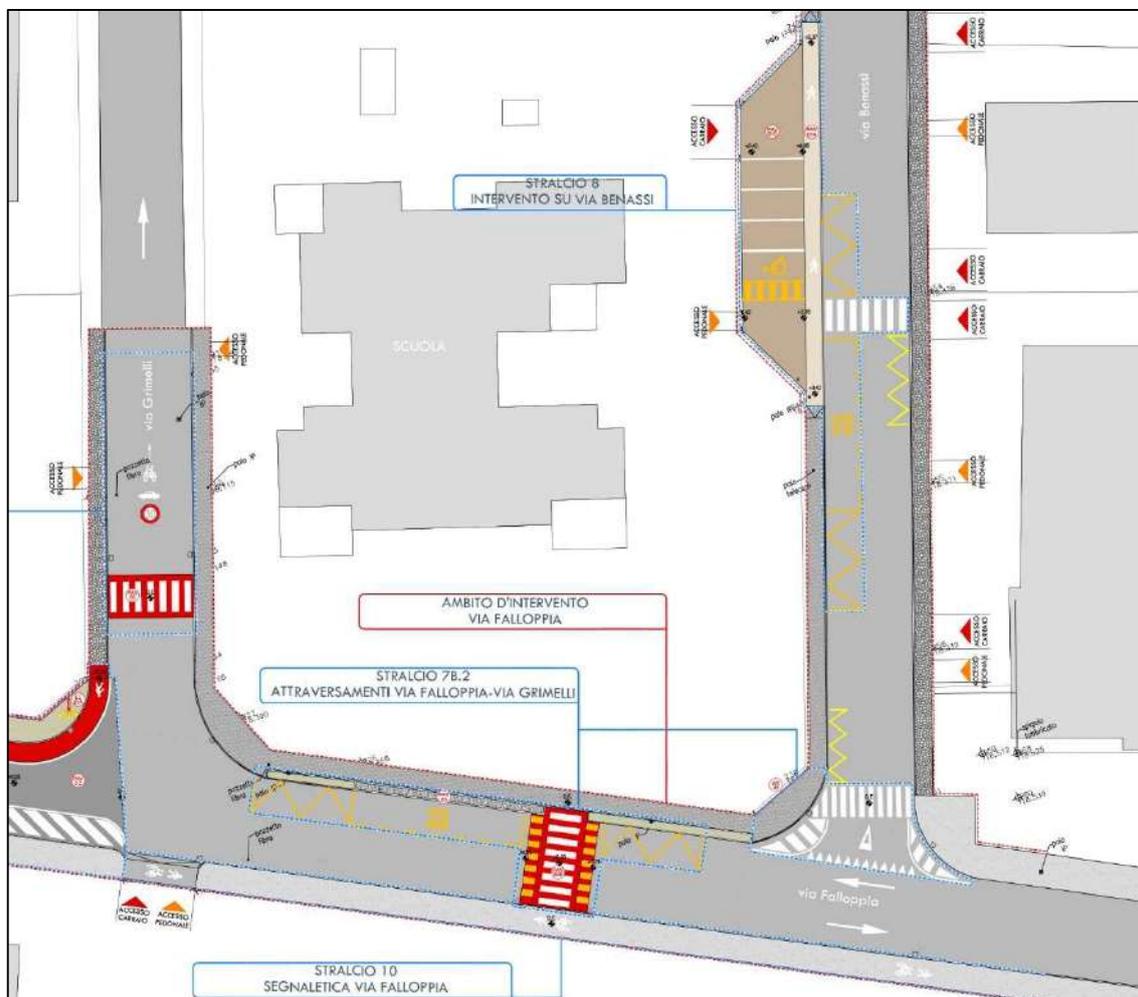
estratto planimetria di progetto Scuola dell'Infanzia
